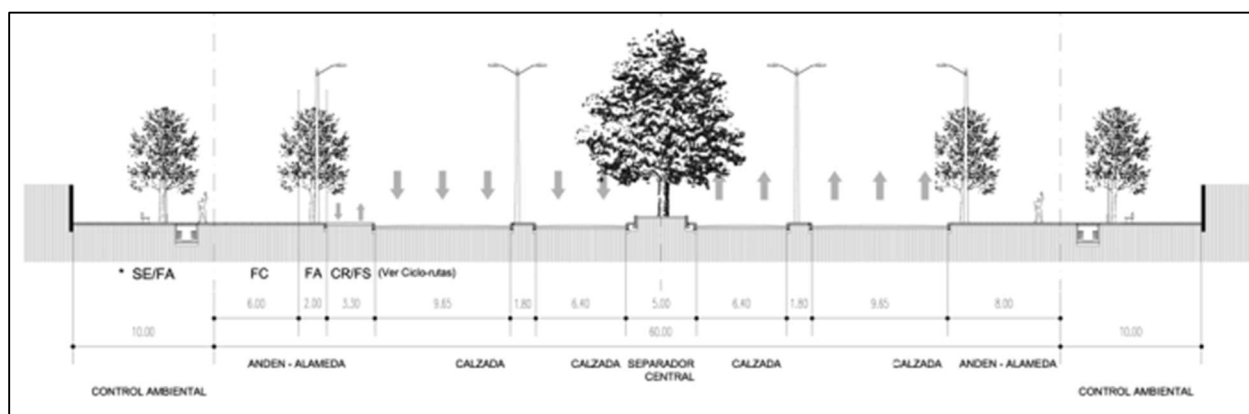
Sección vial tipo A2. Secretaría Distrital de Planeación.
